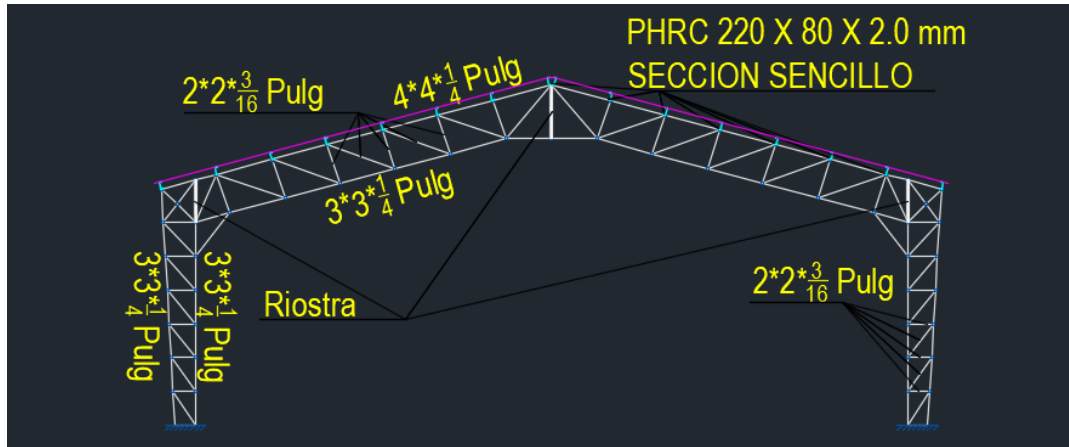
Vista frontal estructura metálica Escenario Deportivo Chamicueto. Fuente: planos estructurales
